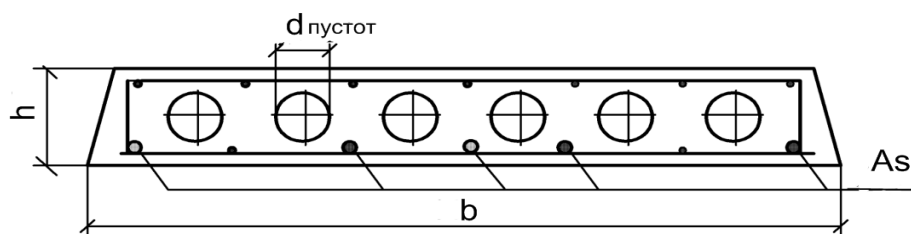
Сечение многопустотной железобетонной плиты: b – ширина плиты; h – толщина плиты; A_s – суммарное сечение арматуры; $d_{пустот}$ – диаметр пустот
